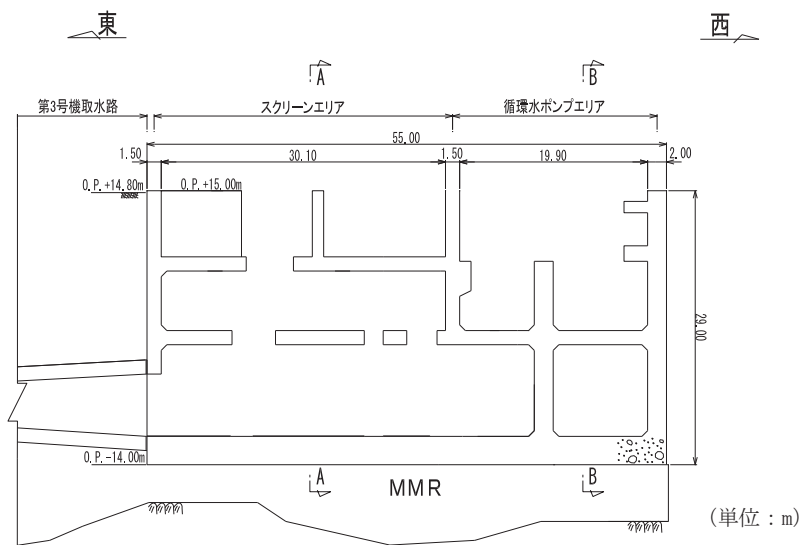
第 3 号機海水ポンプ室断面図 (C-C 断面)
